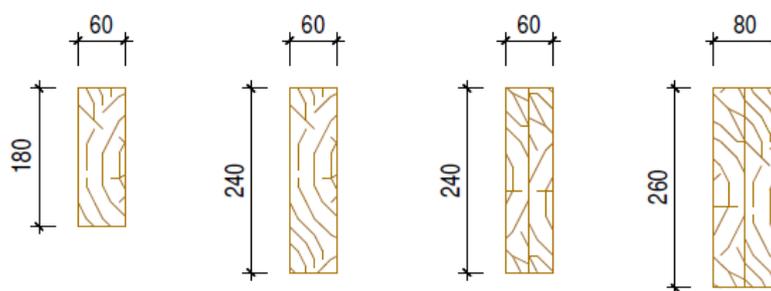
Exemples de sections pour des planches de grandes longueurs bois massif abouté ou type Duo, séchées et classées mécaniquement
